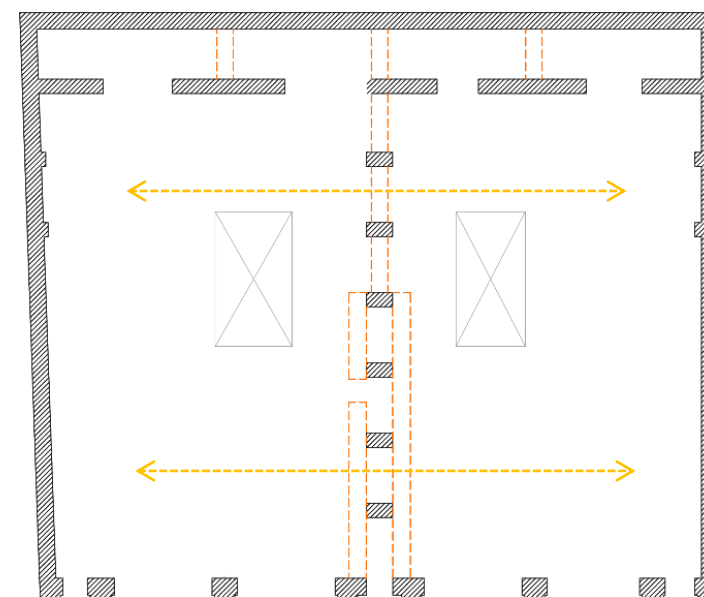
Esquema apertura de planta edificio Gaio Peirano. Fuente:
